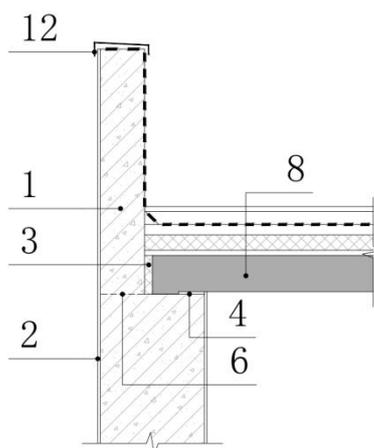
高热阻轻骨料混凝土外墙构造
